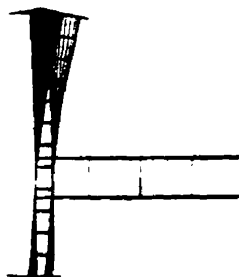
Poutre avec raidisseurs transversaux simples et raidisseur longitudinal, section
